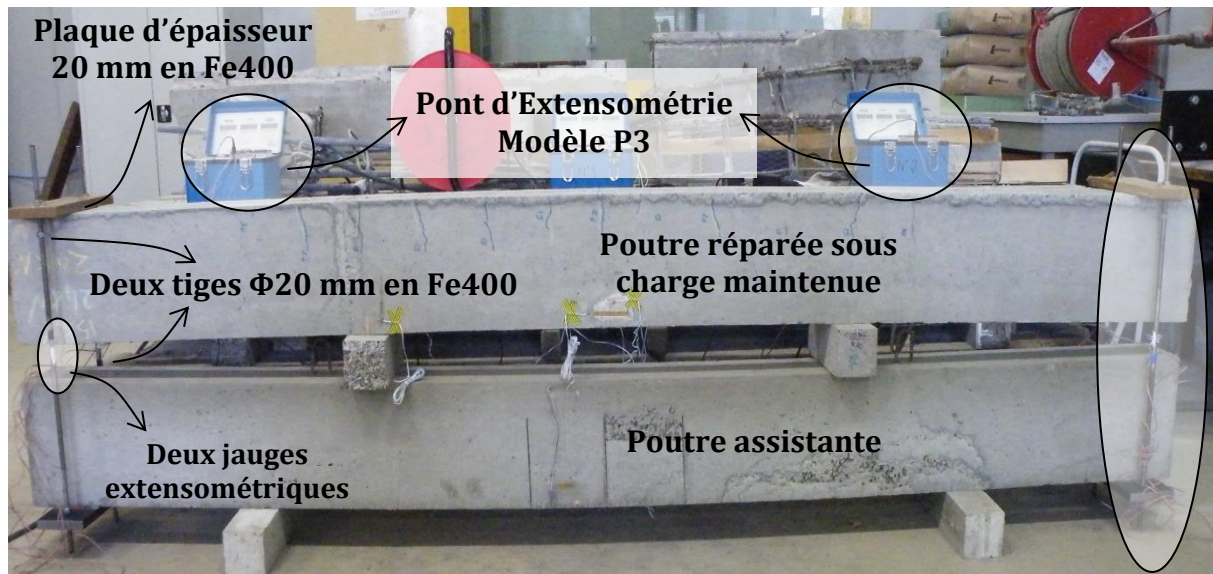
Dispositif de mise de charge maintenue pour les poutres P.
